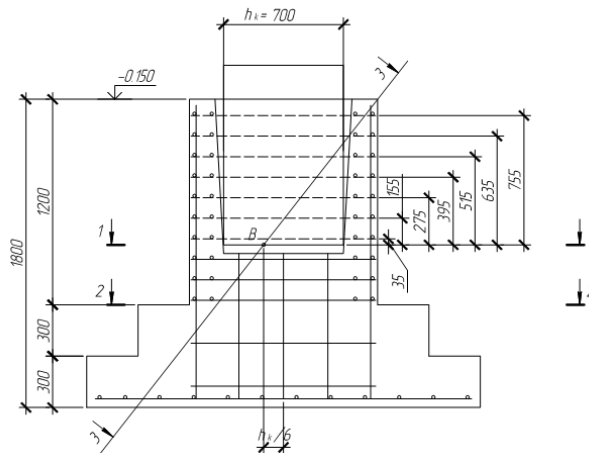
Сечения для расчета поперечной арматуры подколонника
